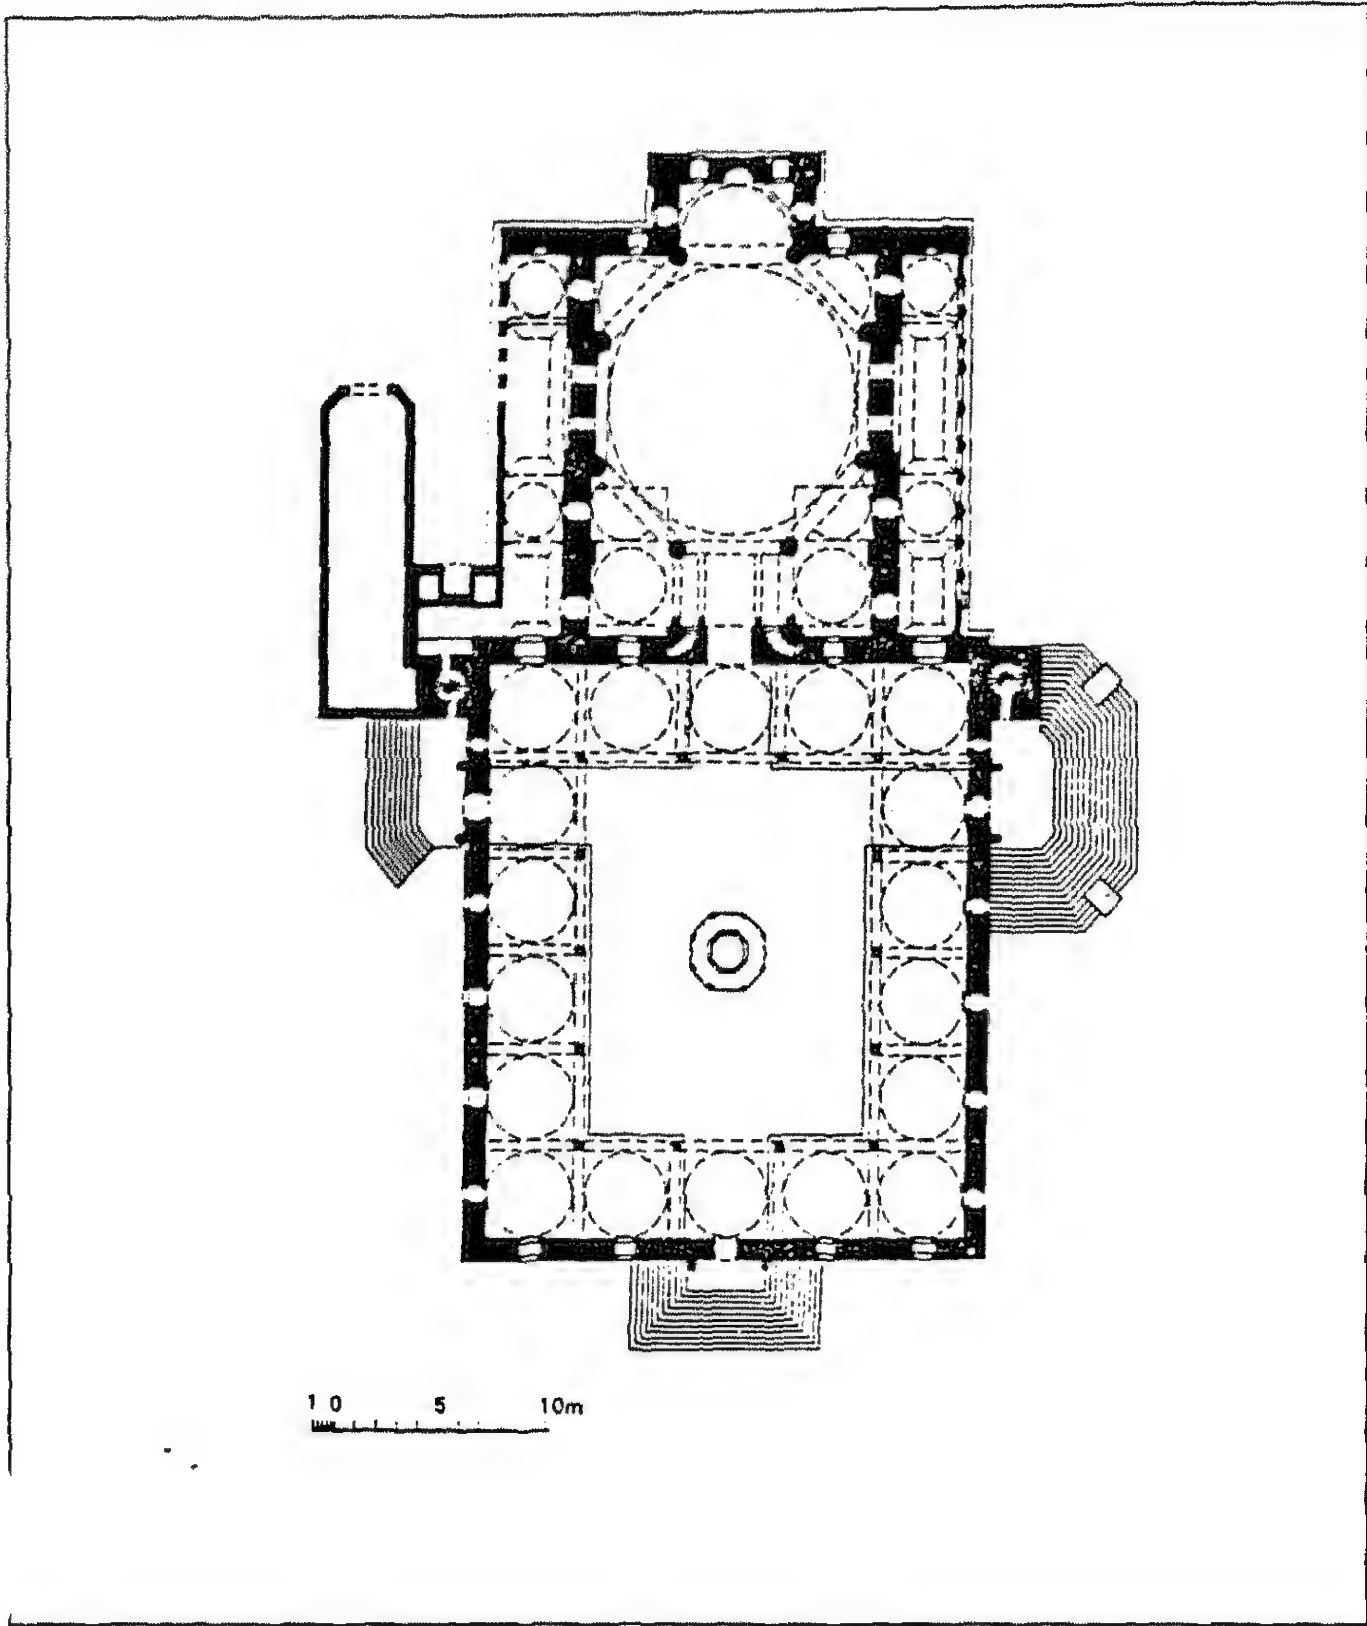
مسقط أفقي لمسجد السليمية في إستانبول (عن : جابريل) .
